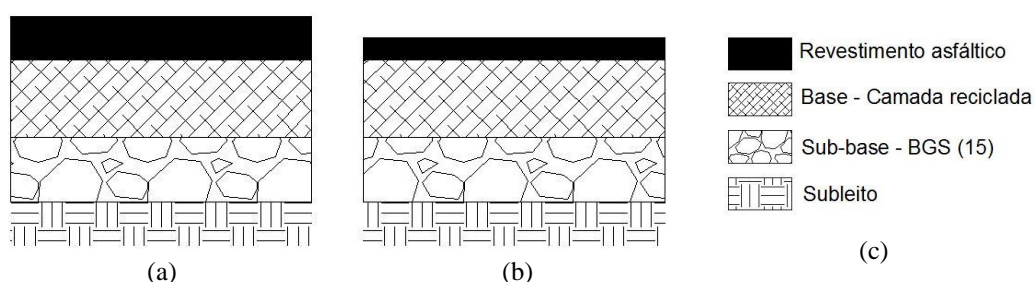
Estruturas de pavimento modeladas – padrão geral: (a) revestimento de 5 cm de espessura, (b) revestimento de 10 cm de espessura, (c) legenda. Medidas em cm
